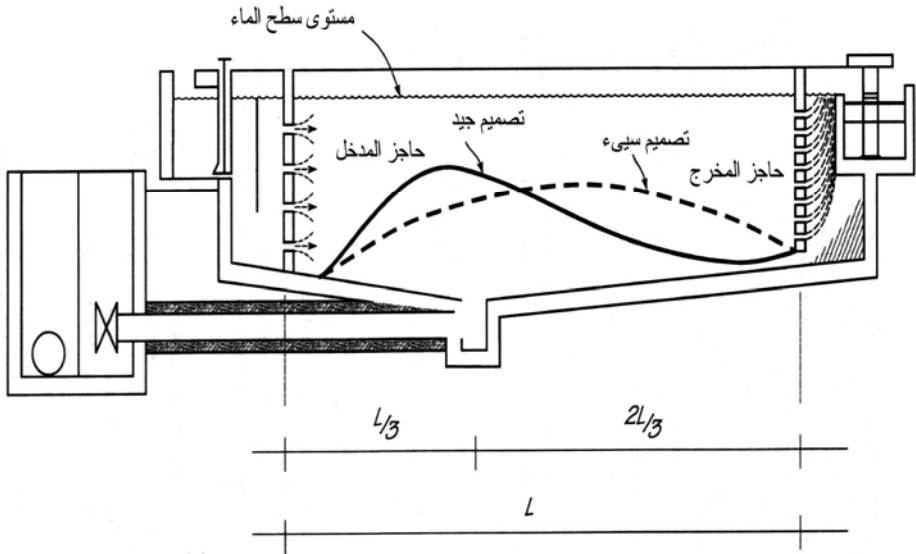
مسقط أفقي لخزان السيب النهائي
